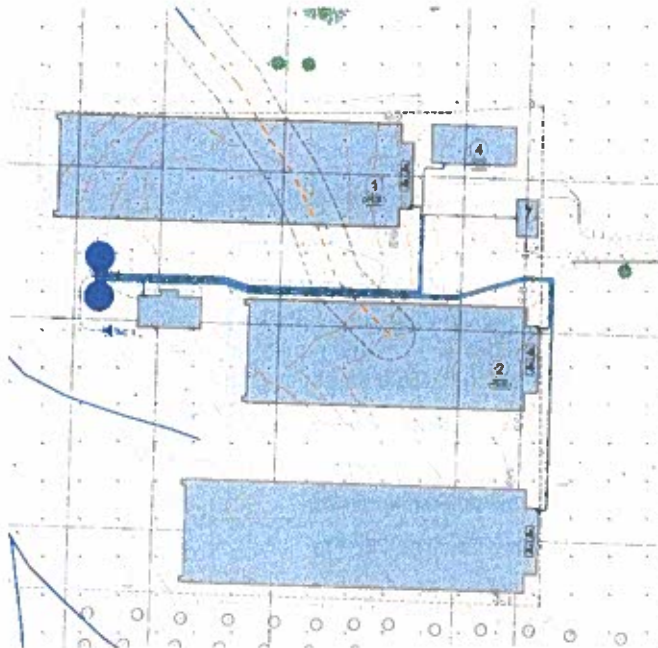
Enquadramento dos reservatórios de água e da captação a construir (AC1) na planta de implementação
